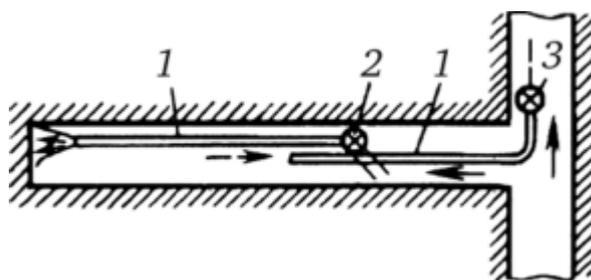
Схема нагнетательного способа проветривания тупиковой выработки
